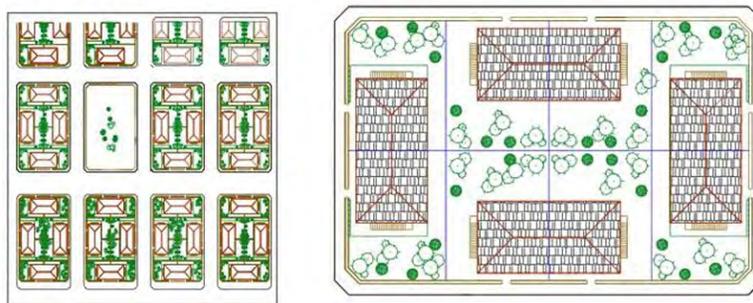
Initial plan and typical plot plan of RWCD (Source: Madani, S.).
